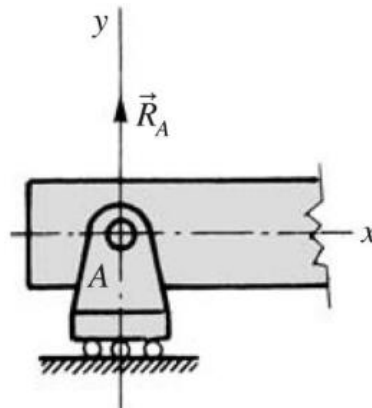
Apoyo articulado (8.- Apoyos y enlaces entre elementos estructurales., s. f.)
